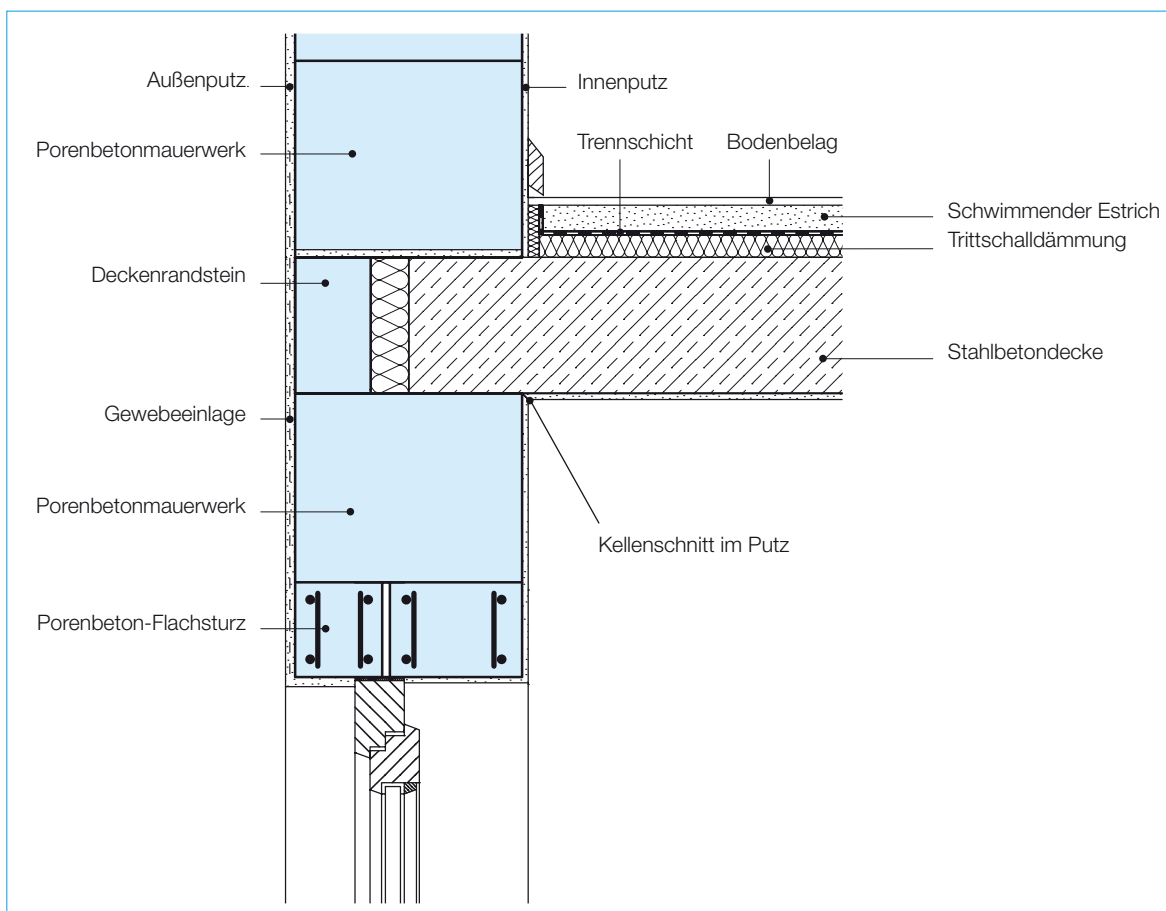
Einschalige Außenwand aus Porenbetonmauerwerk mit Stahlbeton-Geschossdeckenanschluss und Porenbeton-Flachsturz
